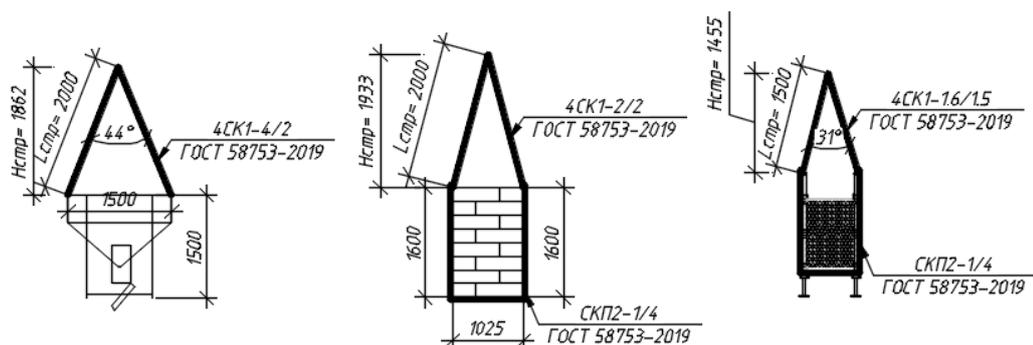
«Определение длины стропов для бады с бетоном и опалубки перекрытия» [27]
